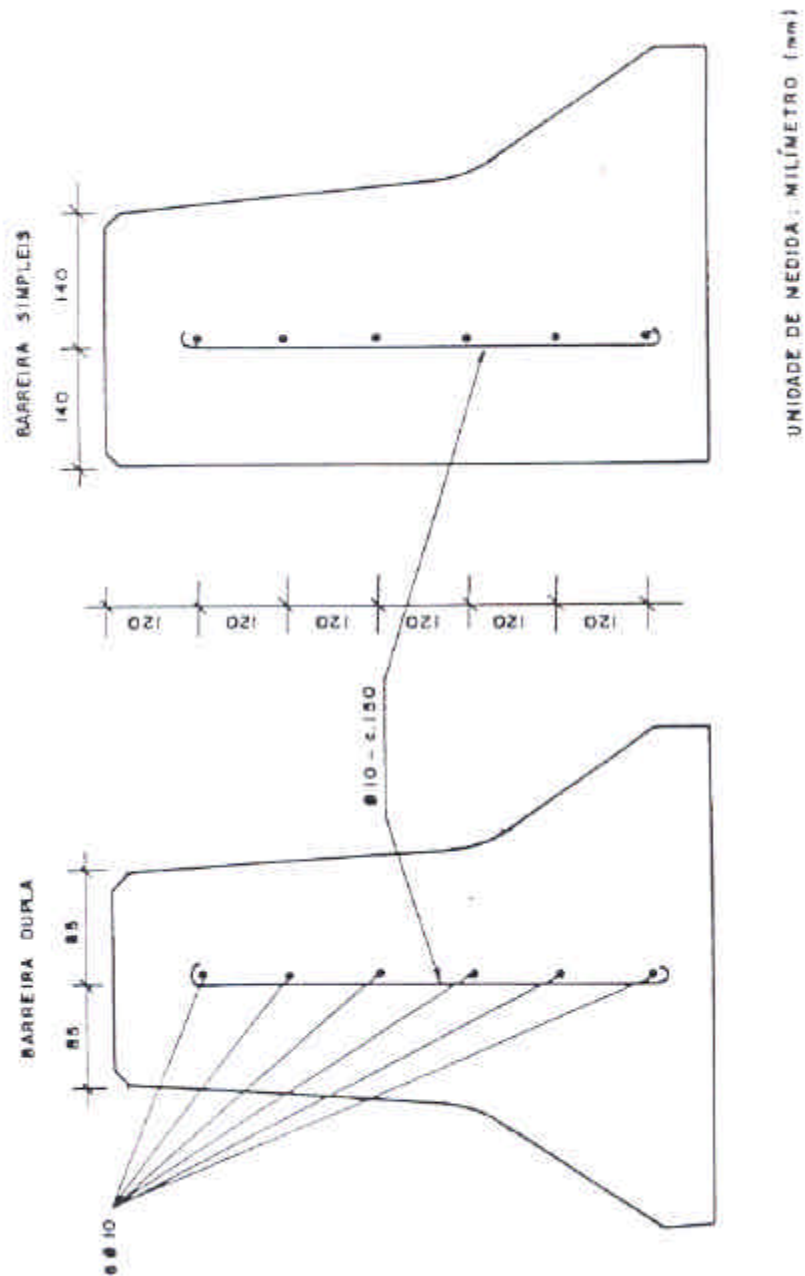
ARMADURA DA EXTREMIDADE DA BARREIRA
